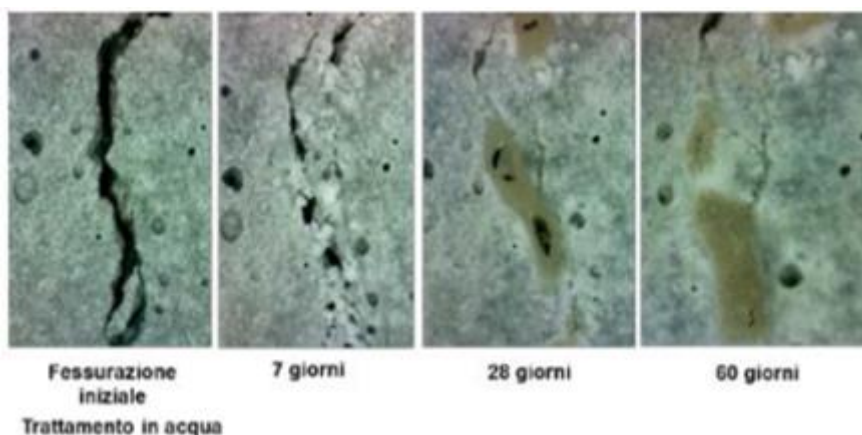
trattamento di impermeabilizzazione del calcestruzzo
